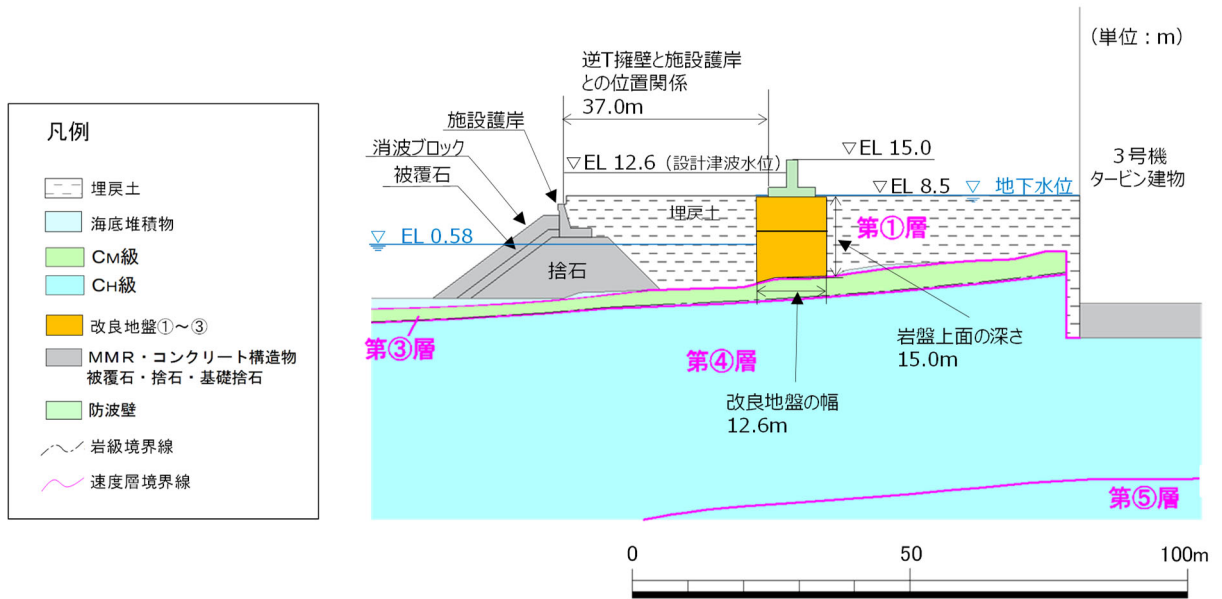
防波壁（逆T擁壁）の横断面図（④-④断面）
